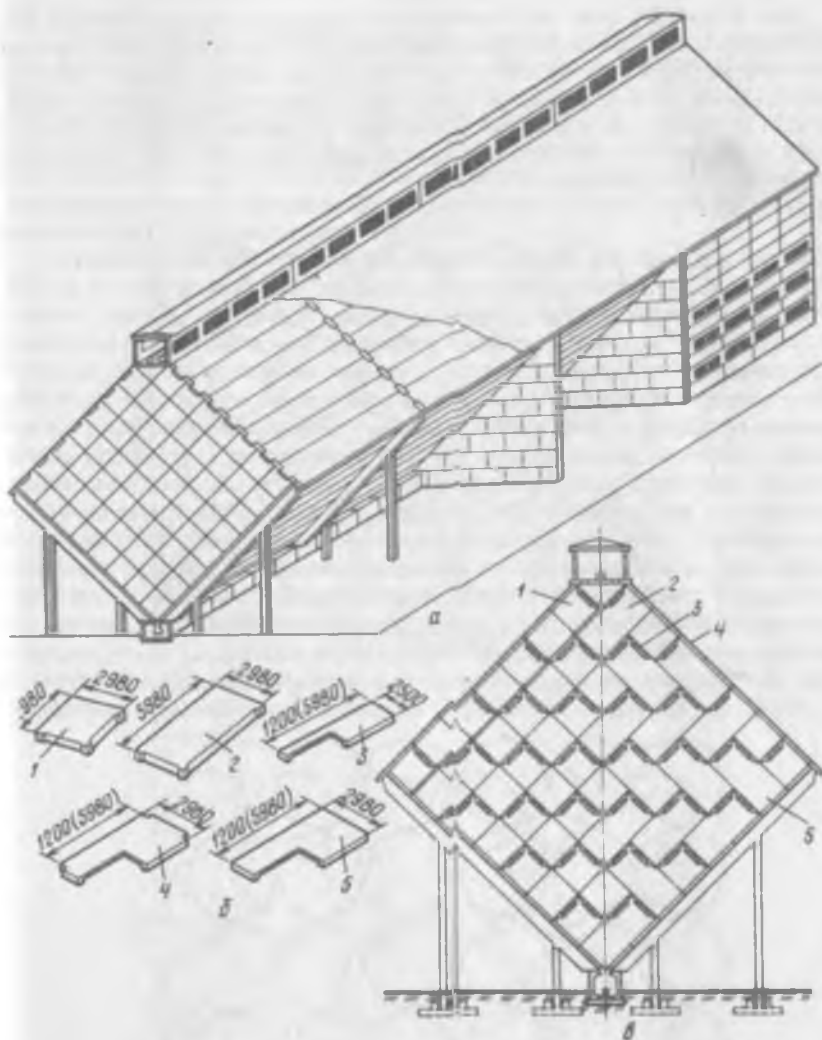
Сборный силосный корпус с горизонтальными силосами:
